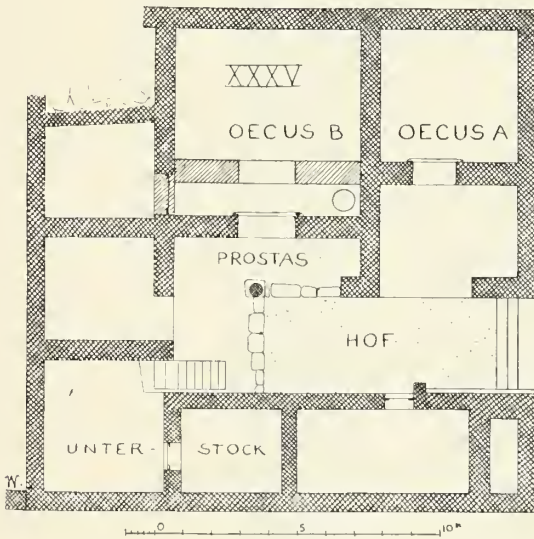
Grundriss des Hauses Nr. XXXV.
